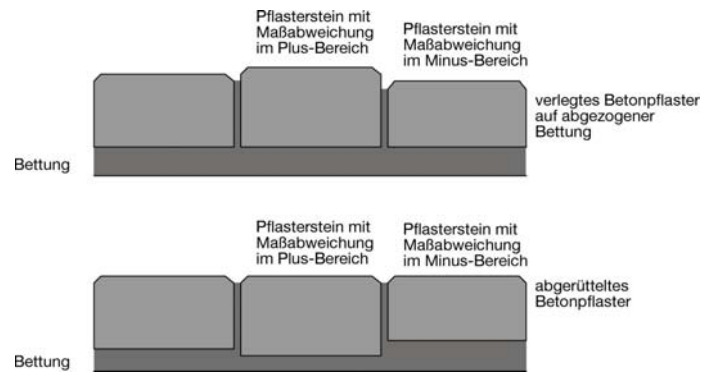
Ausgleich zulässiger Dickentoleranzen der Betonpflastersteine innerhalb der Bettung
